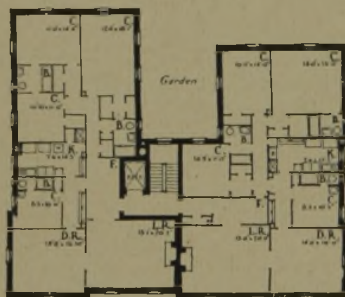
Grundriß eines Hauses obiger Gruppe mit je 2 Siebenzimmer-Wohnungen.
